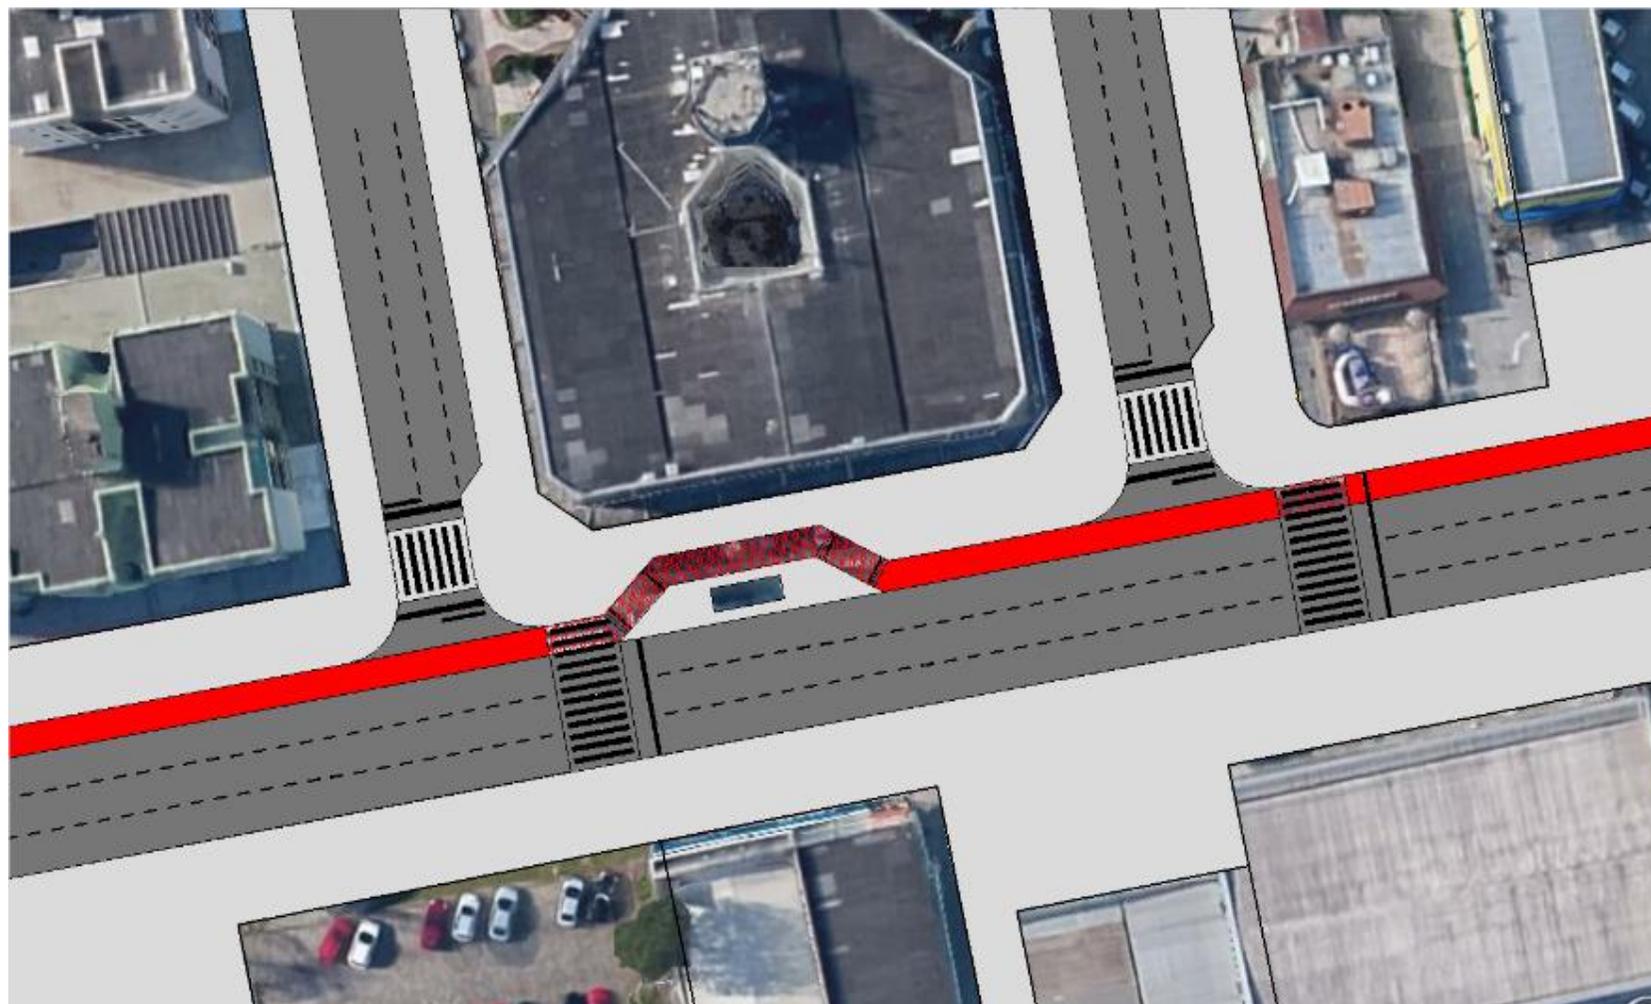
Planta ilustrada com a proposta para a Av. Pres. Kennedy
